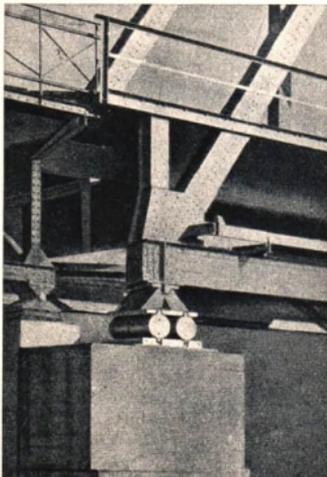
Walzenlager auf dem Pfeiler einer Eisenbahnbrücke
